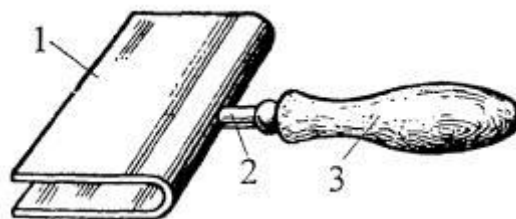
Захоплення для відколювання смуг глазурованих плиток: 1 – сталева пластина; 2 - стрижень-тримач; 3 - рукоятка
